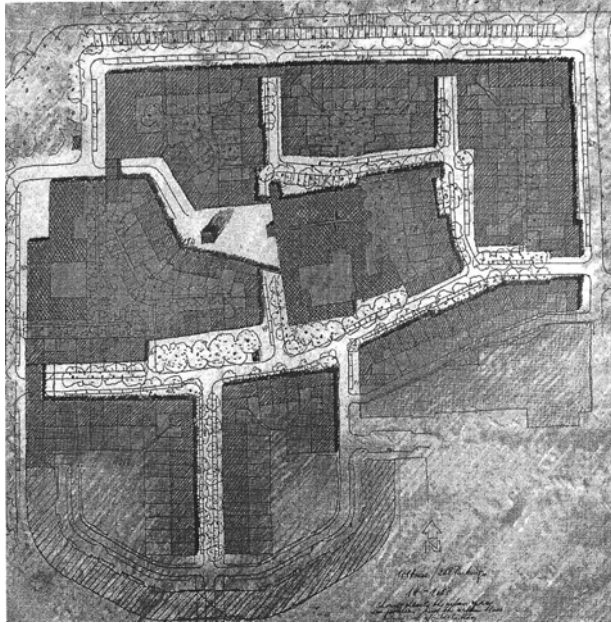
Planta da disposição da primeira fase de construção, com a igreja e o jardim de infância existentes no meio – Noorderhof, Amsterdão
